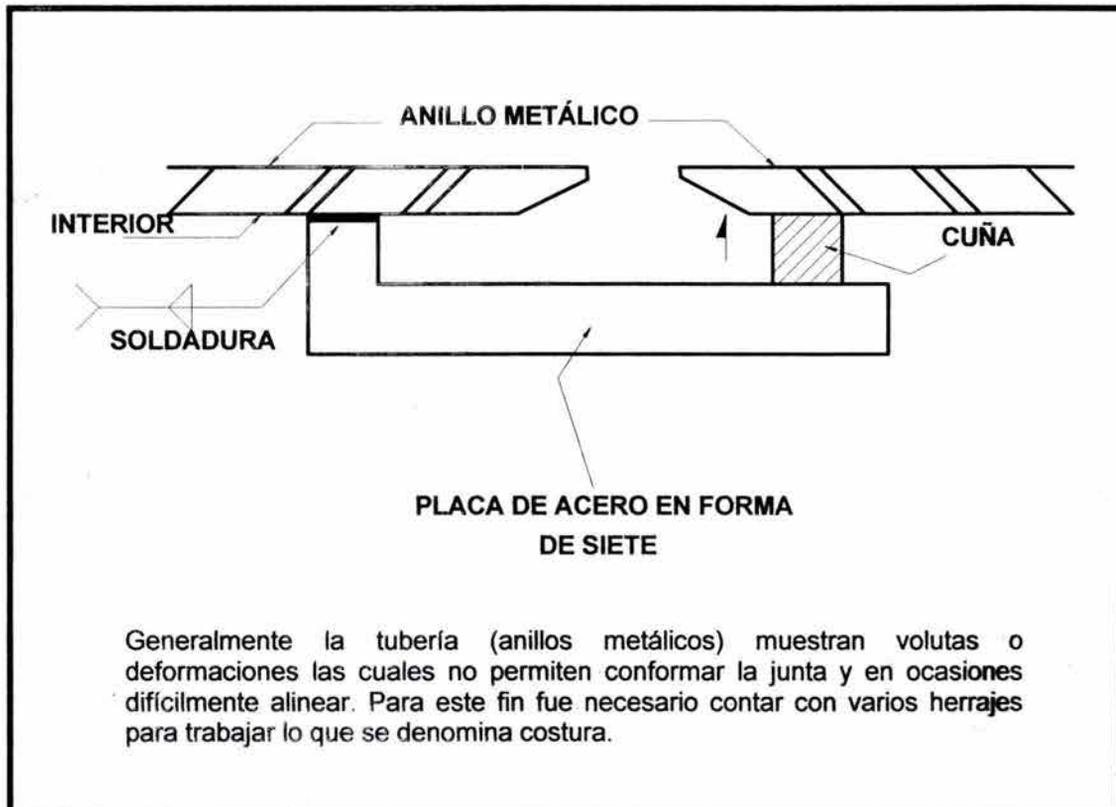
ALINEAMIENTO DEL BLINDAJE METÁLICO
